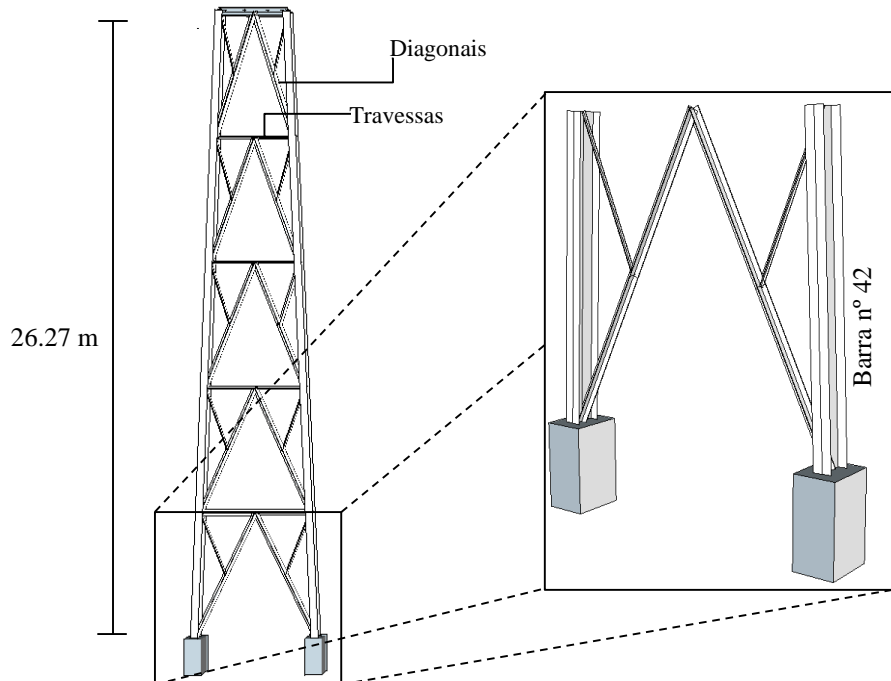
Cordões Exteriores do Pilar e da Barra n.º 42
